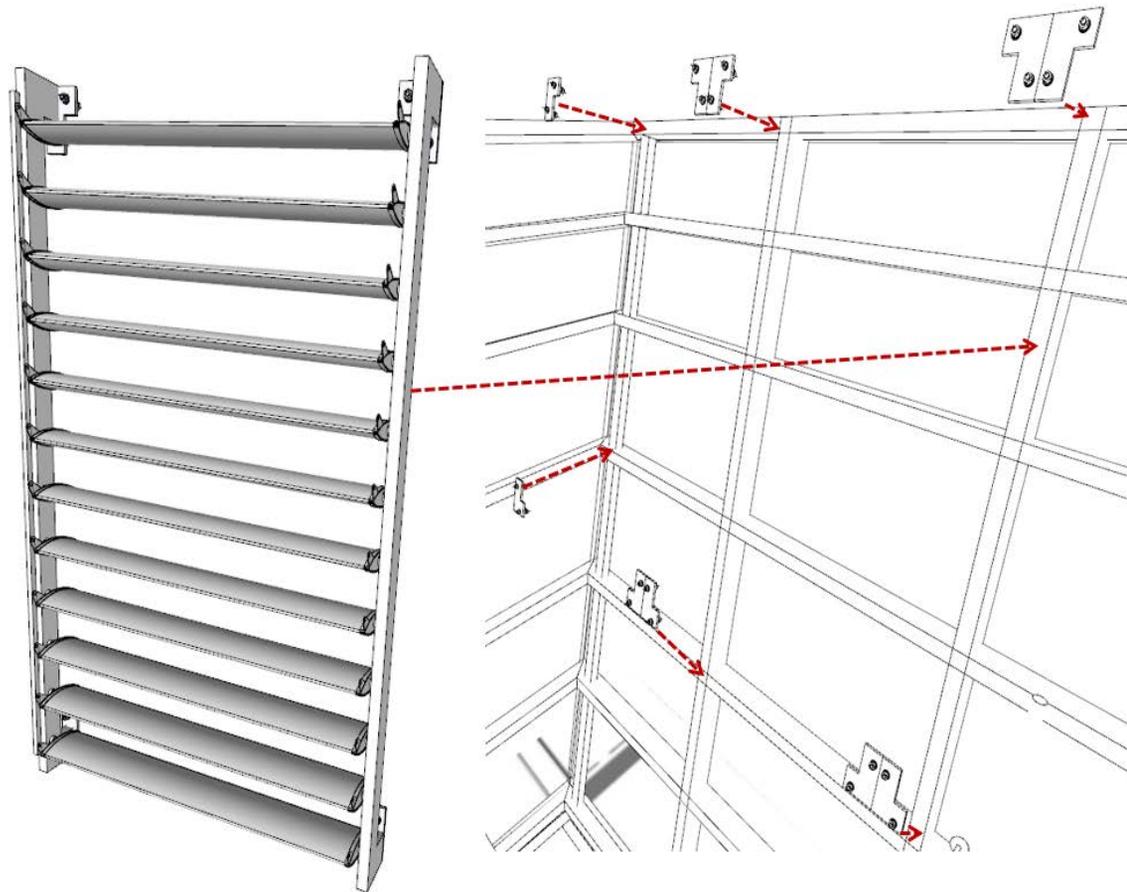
Gómez, C. (2020). Detalle constructivo 1 anclaje de cortasol herramienta Sketchup.
